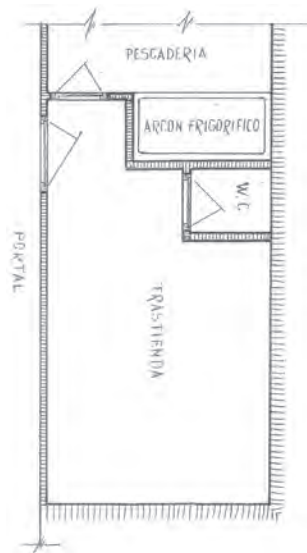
22. 1971 PLANTA DE LA TRASTIENDA DE LA PESCADERÍA
